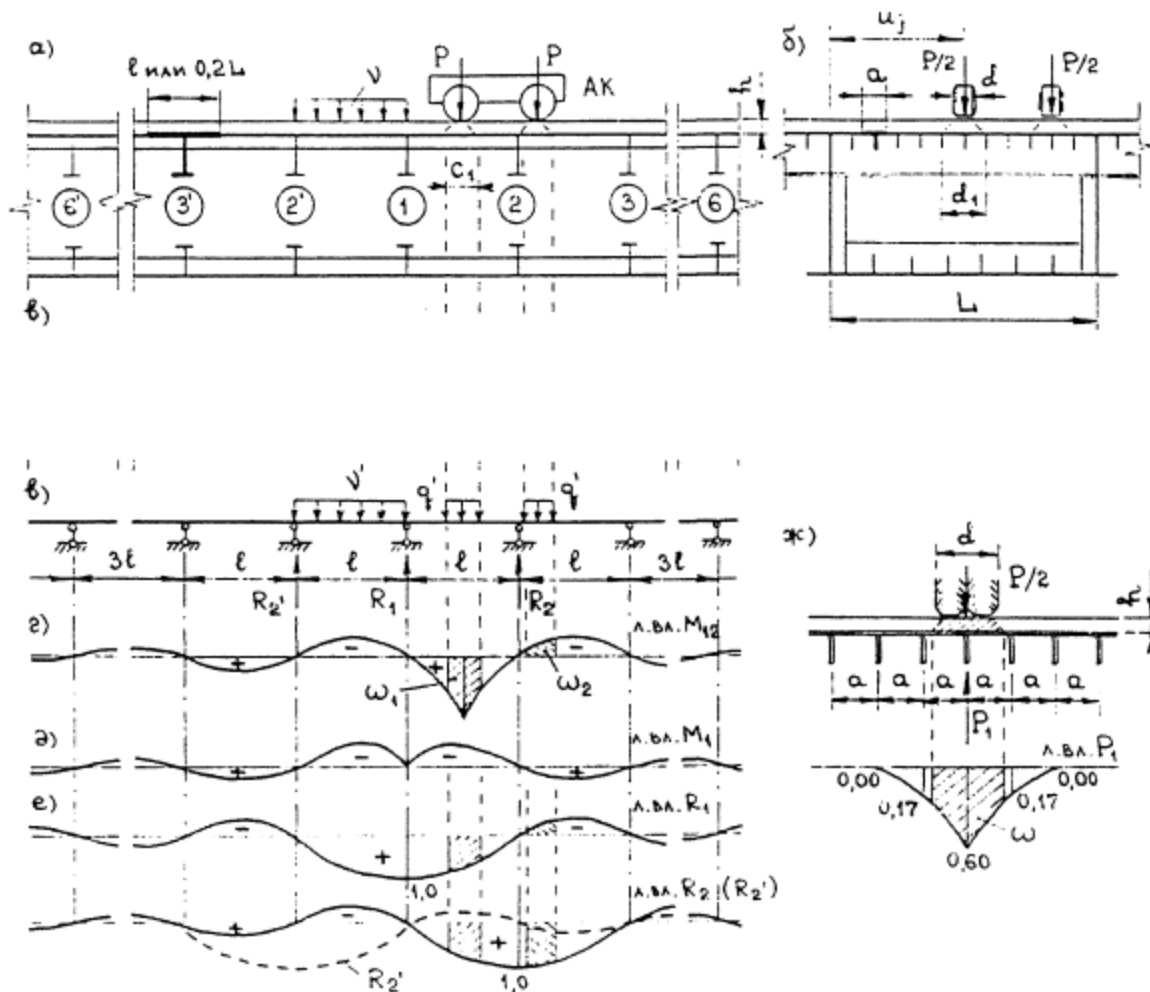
Схемы и линии влияния к расчету ортотропной плиты.
